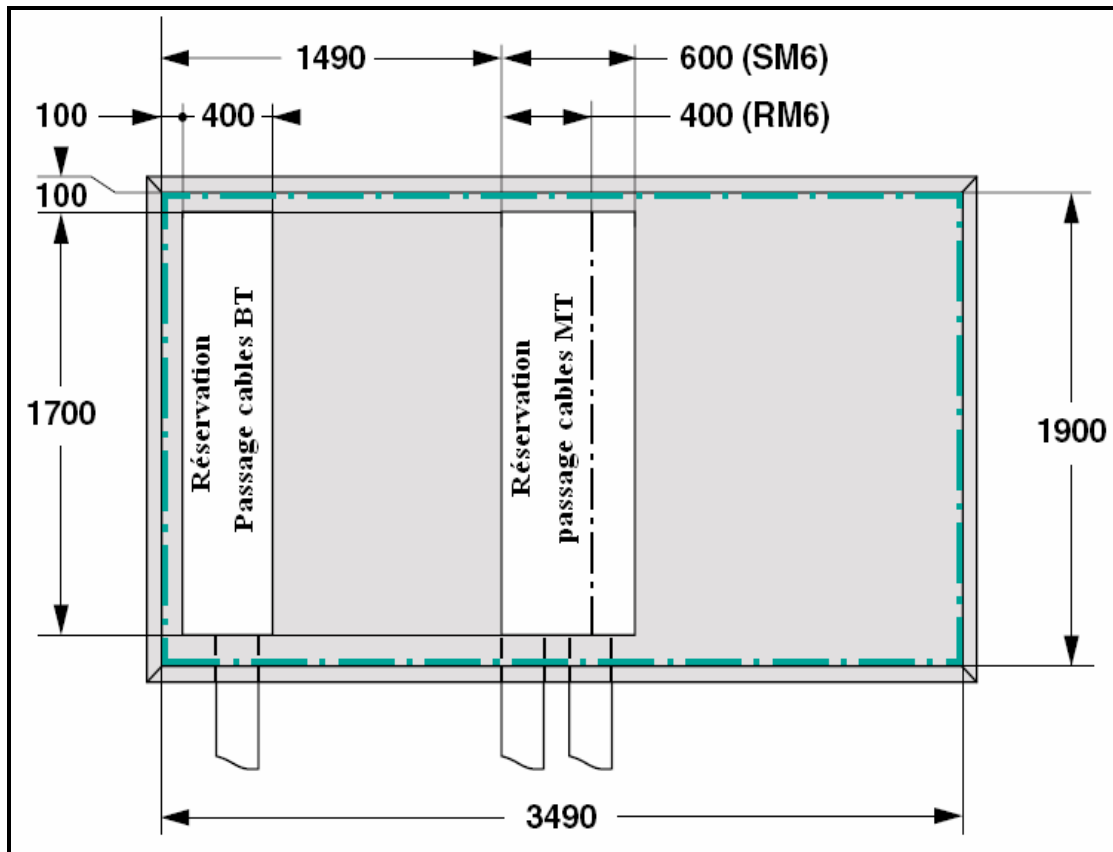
Dalle béton vue en plan d'un poste préfabriqué
